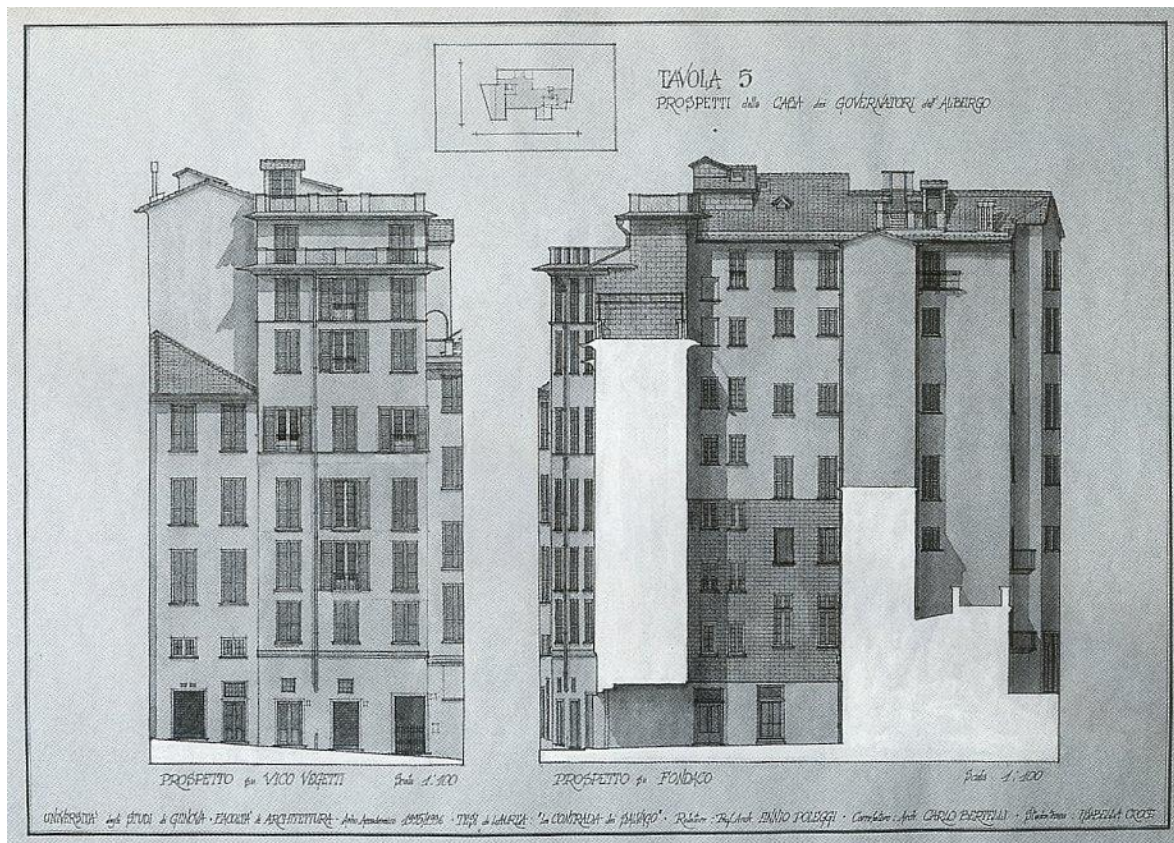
Prospetto su Vico Vegetti e sezione sul fondaco.
